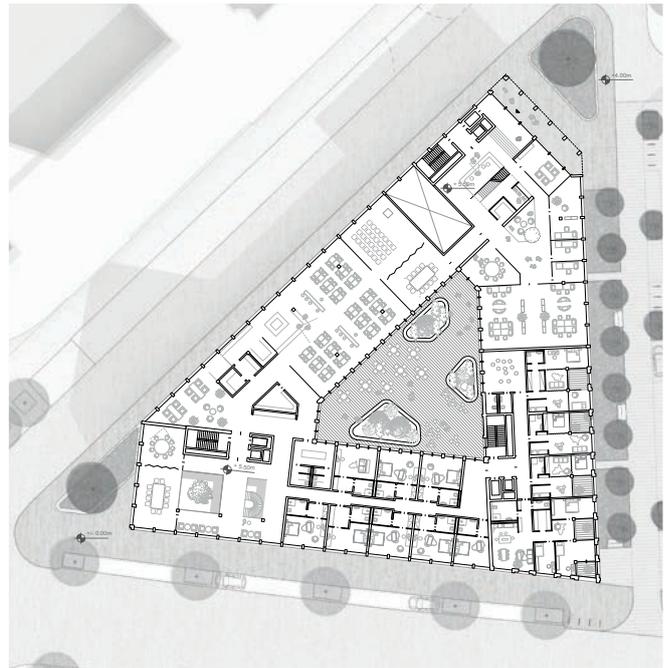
Beispielgrundriss 1.OG mit Eingang Nord Büroflächen o.M.
